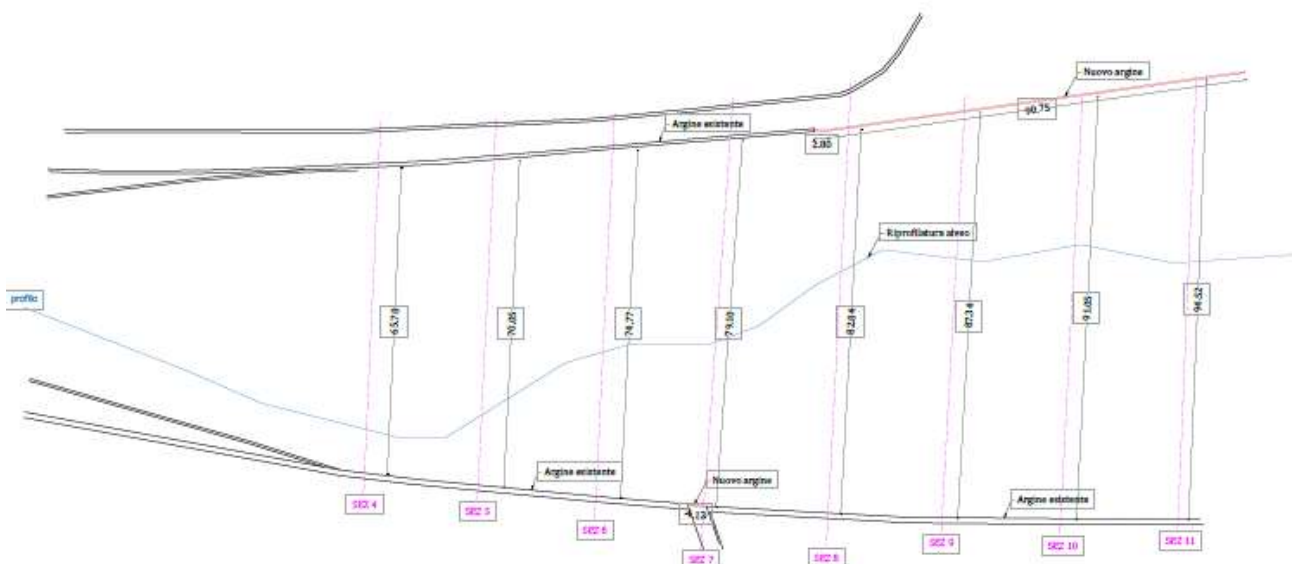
Planimetria ubicazione interventi. 2° Intervento
